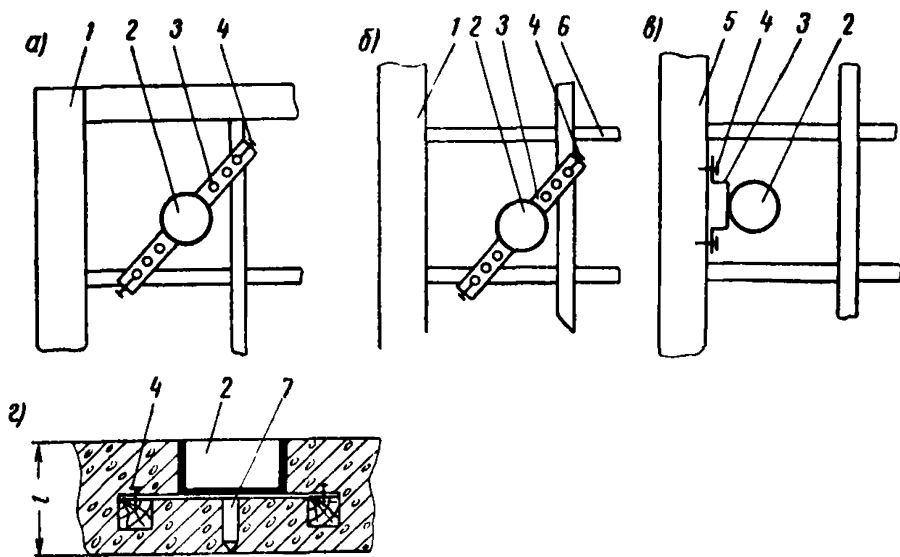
Закрепление электропроводки на деревянном каркасе гипсолитовой перегородки
